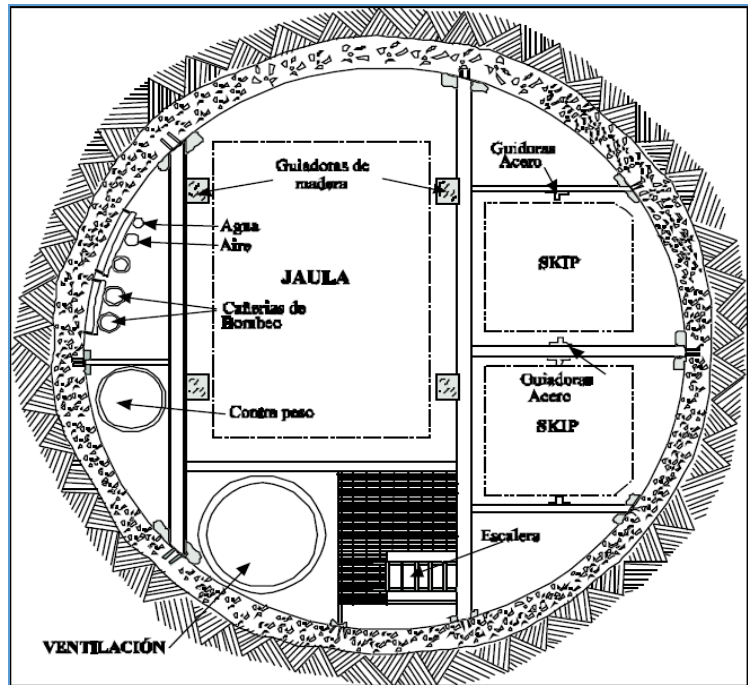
Fortificación circular con hormigón armado (concreto).
